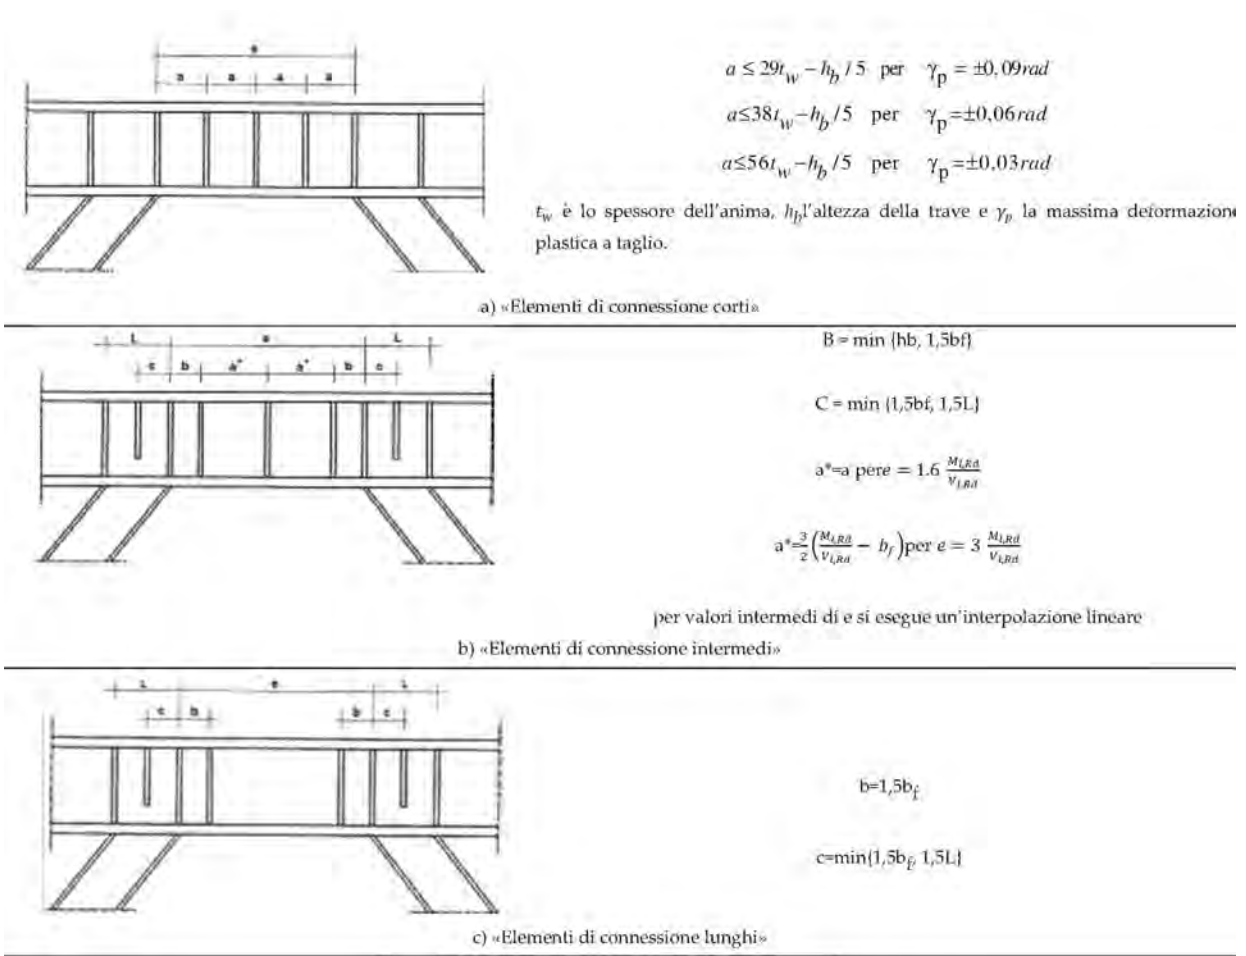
Dettagli costruttivi degli elementi di connessione
